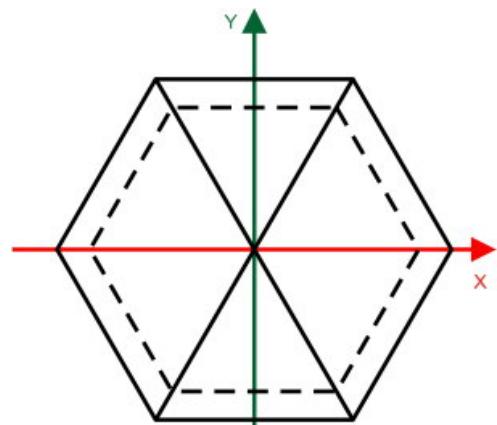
Grundriss unter Berücksichtigung der Dachtraufe
